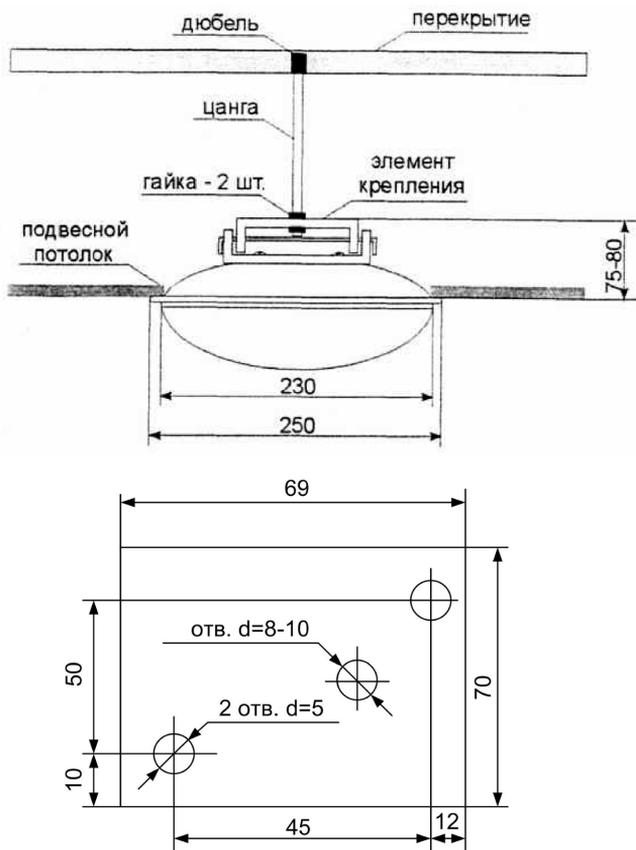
Схема крепления модуля порошкового пожаротушения МПП (р.) «Буран – 2,5» на конструкции перекрытия при наличии подвесного потолка
